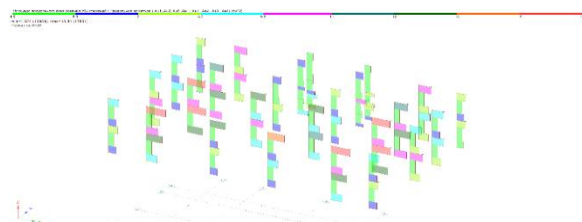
Расположение колонн и максимальная площадь армирование в колоннах на четвёртом и пятом этажах пяти этажного каркасного железобетонного здания с внутренними и наружными стенами из газобетона.
